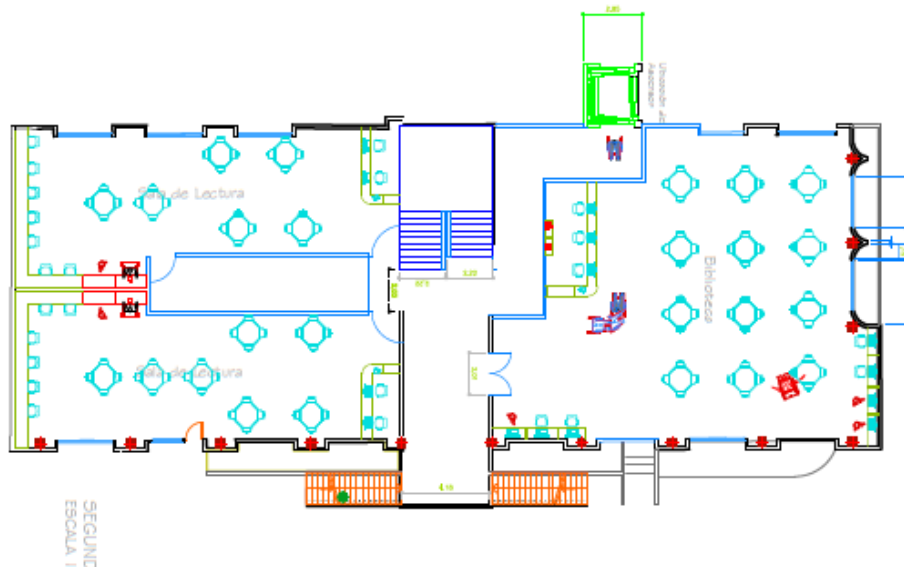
Ubicación del ascensor y corredor adyacente segunda planta
